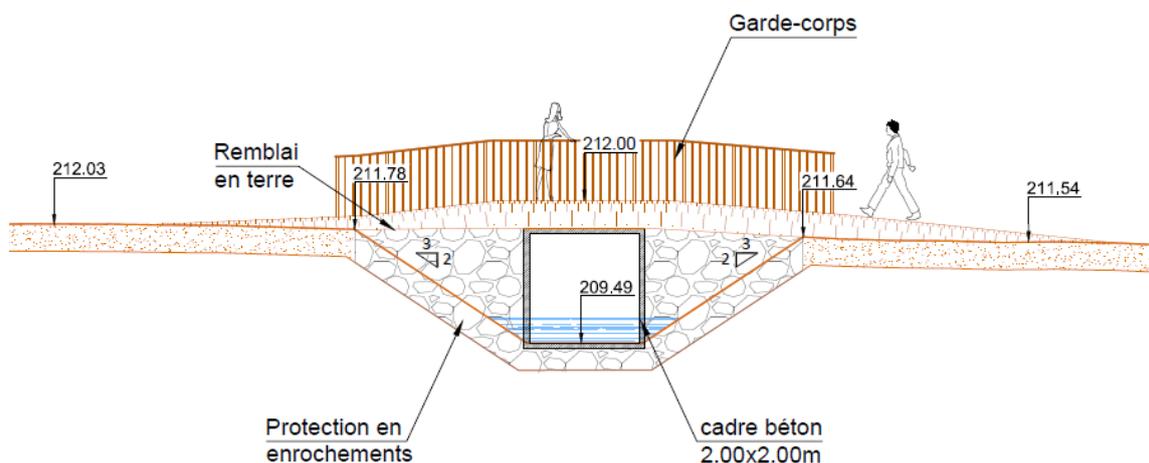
Vue en coupe de l’ouvrage de franchissement sur le bras secondaire au droit de la diffluence
